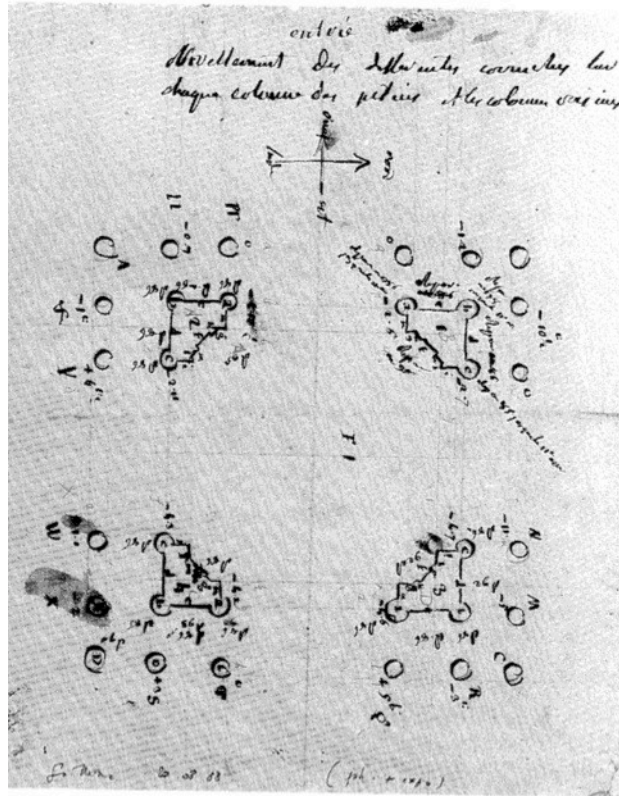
Schema di Gauthey dei quattro pilastri, documento di cantiere.<sup>xlii</sup>
